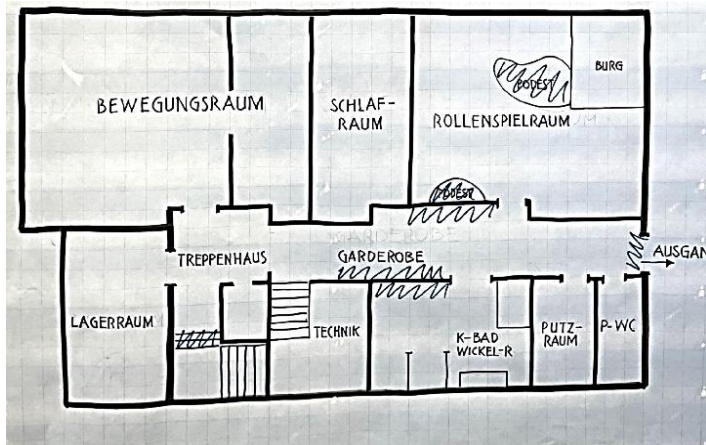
Grundriss einer Kita, hier werden zur Bearbeitung die einzelnen Raum- und Material-Bestandteile hineingelegt
